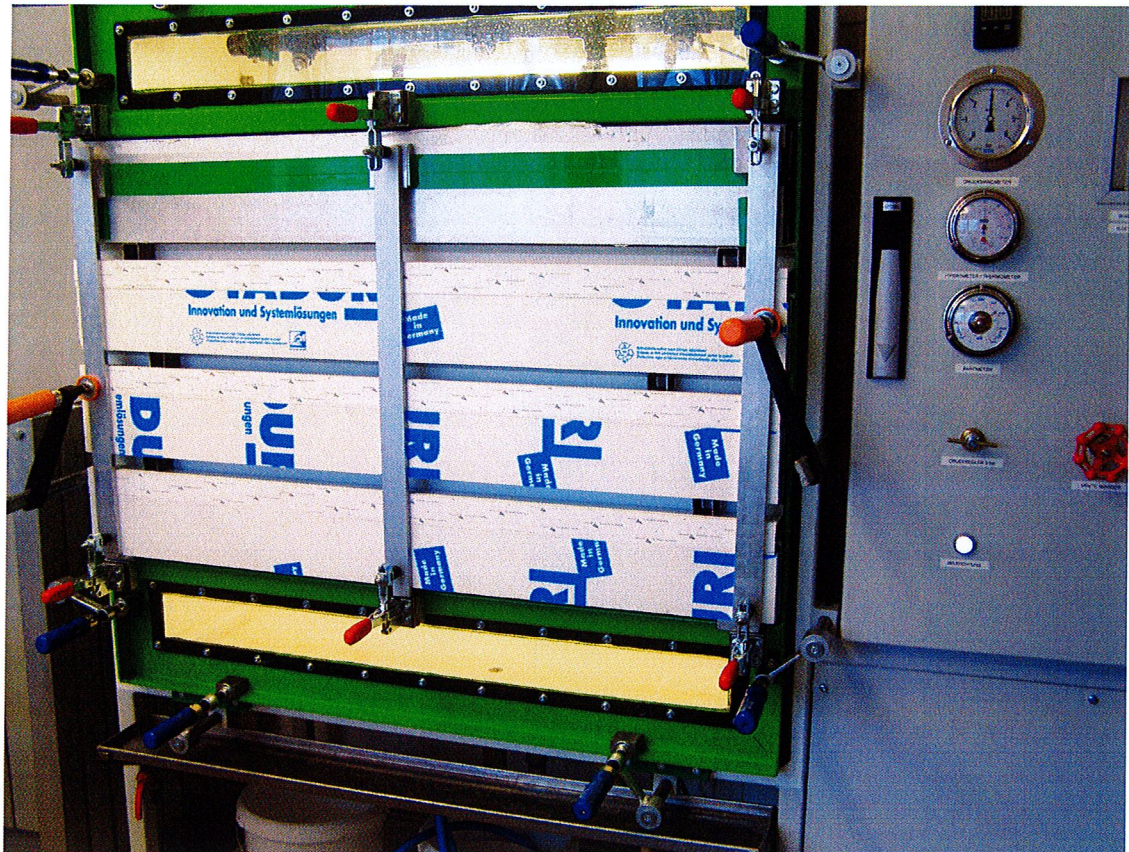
waagrecht in den Prüfstand Schwellprofil eingebaute Prüfkörper mit den Schwellprofilen.
